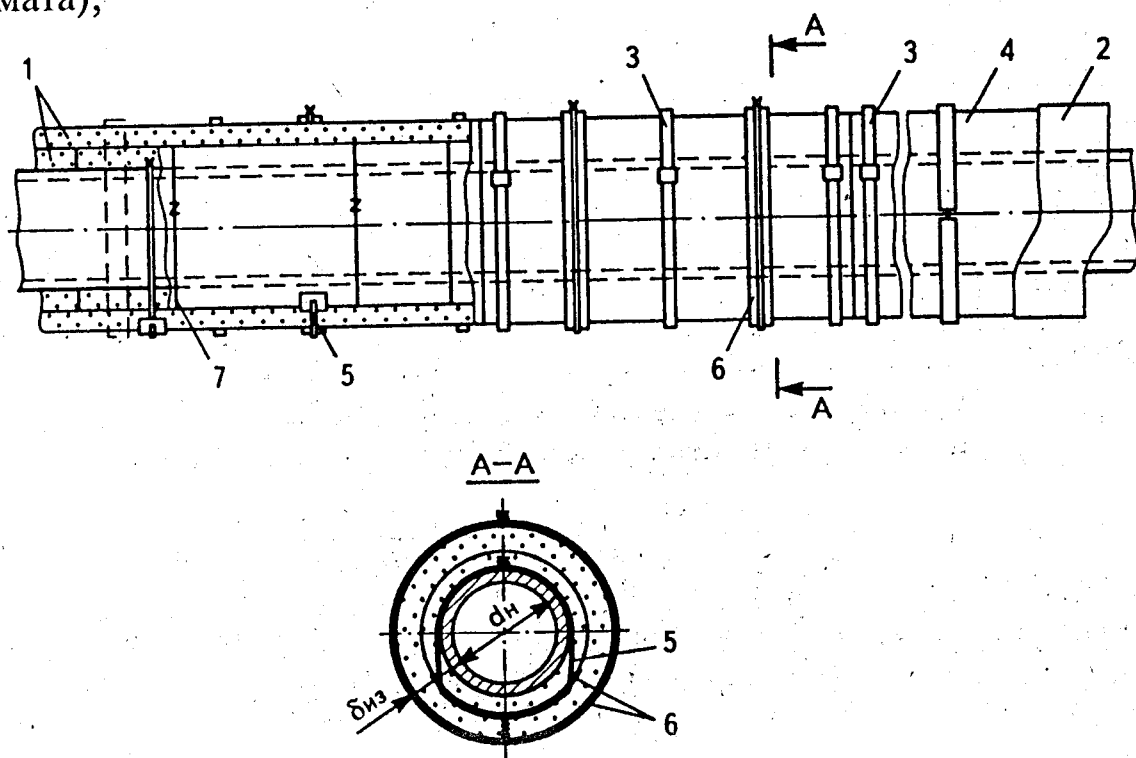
Изоляция трубопроводов теплоизоляционными матами в два слоя с креплением бандажами и подвесками:
